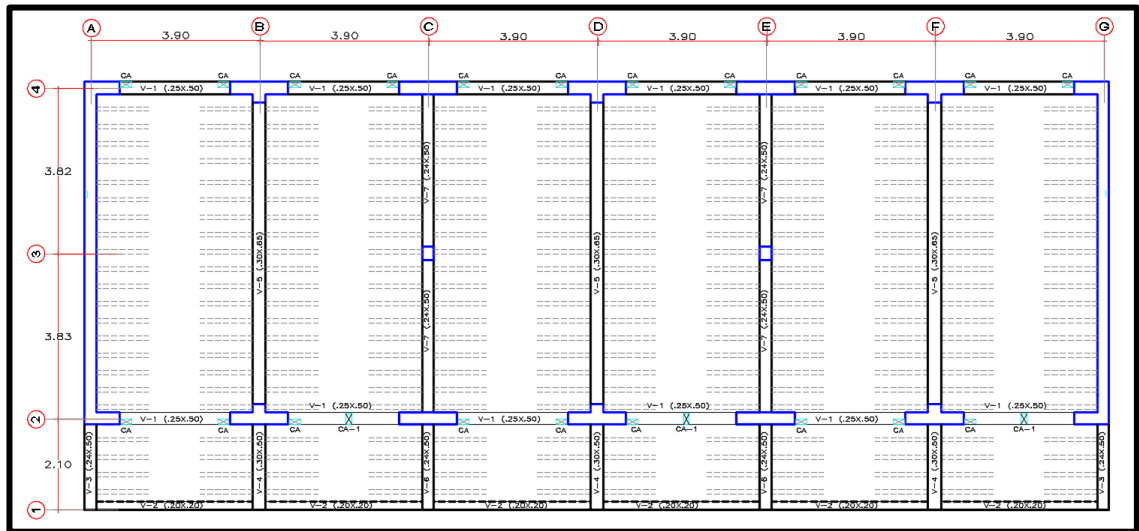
Plano de la Losa Aligerada y Vigas en el Software AutoCAD 2015.
